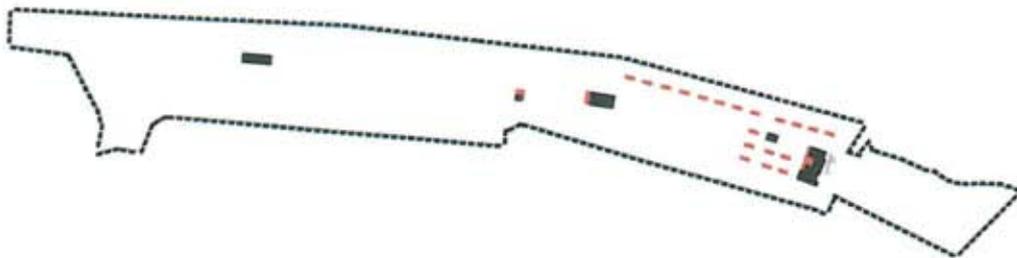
Vergleich Bestandsgebäude (schwarz) und Planung (rot)
